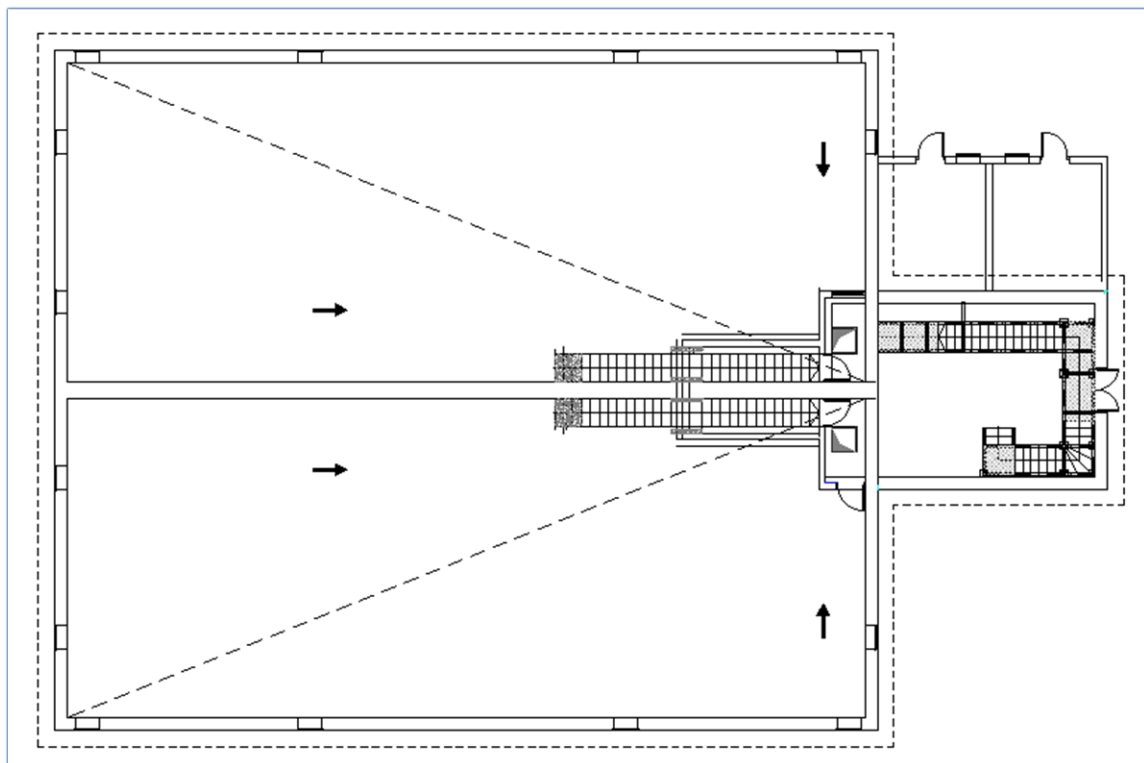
Ejemplo de depósito existente con dos cámaras y acceso al interior mediante escalera de hormigón.
